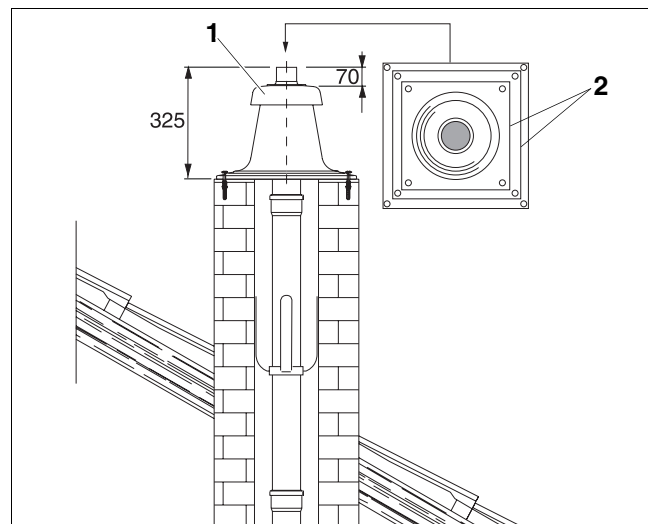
Kaminkopfabdeckung montieren (Maße in mm)
